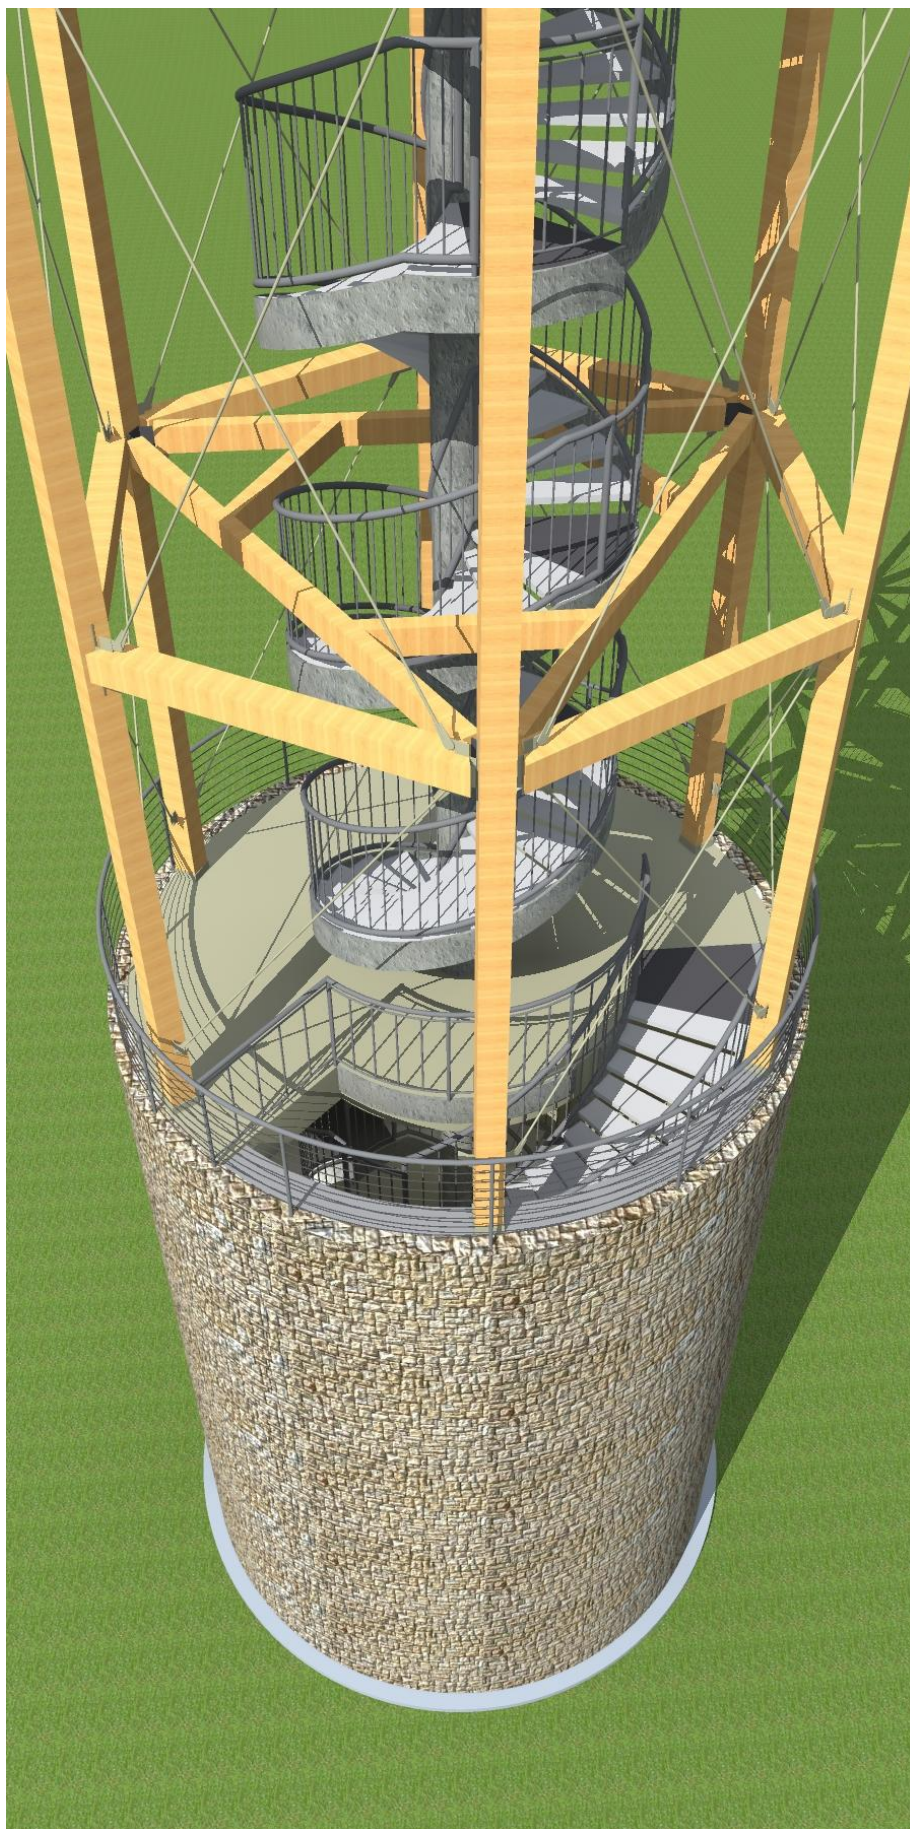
varianta s kruhovým půdorysem a spodním zastřešením – perspektivní pohled
